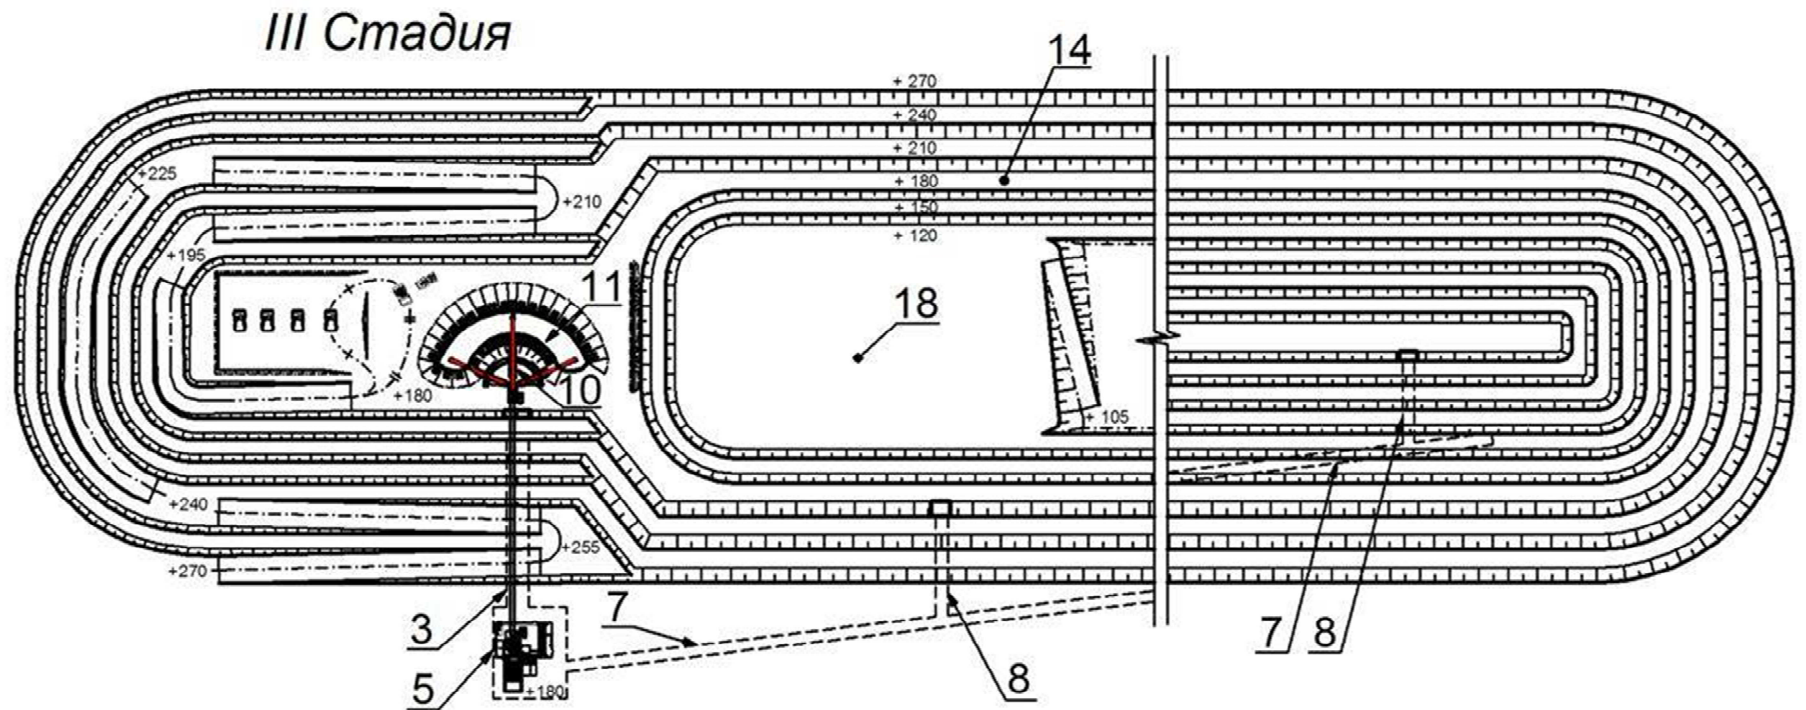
План карьера на конец III стадии разработки: 3 – штольня; 5 – камера; 7 – конвейерный уклон; 8 – квершлаг; 10 – стакер; 11 – штабель дроблёной руды; 14 – предохранительная берма; 18 – внутренний отвал
